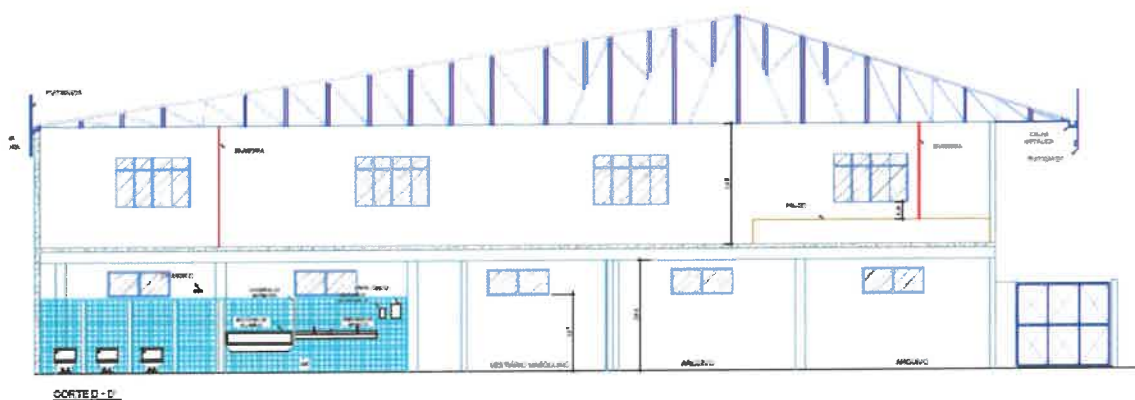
Corte Lateral da Planta da Sede da Cigás
